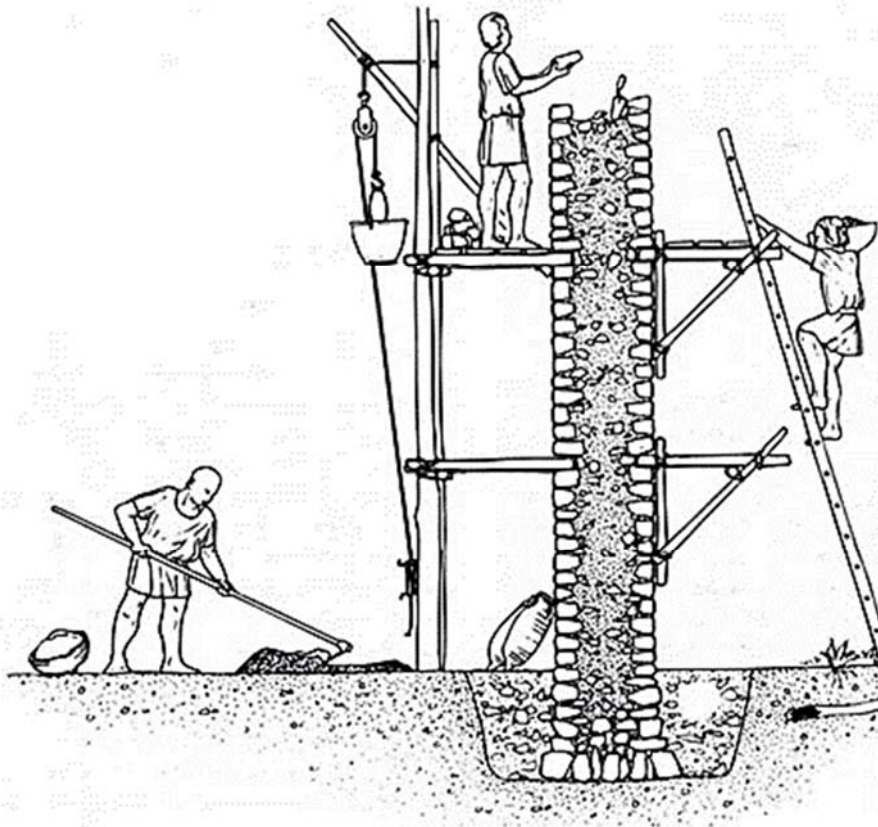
Detalle de ejecución de un muro compuesto mediante andamios empotrados en la masa del muro según J. P. Adam.
